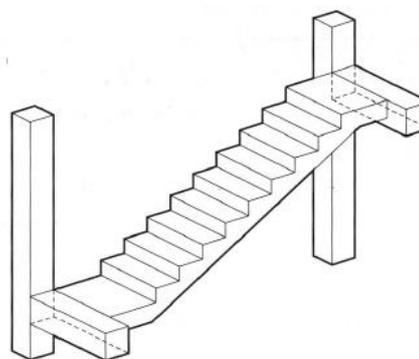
Schema tridimensionale di scala a soletta rampante
